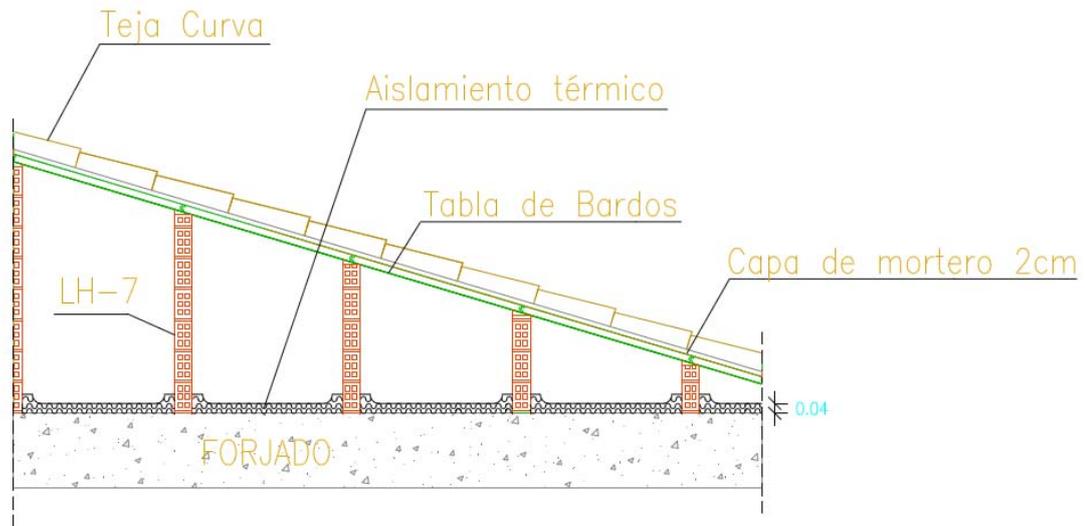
Detalle constructivo de la cubierta con tabicón según proyecto.
